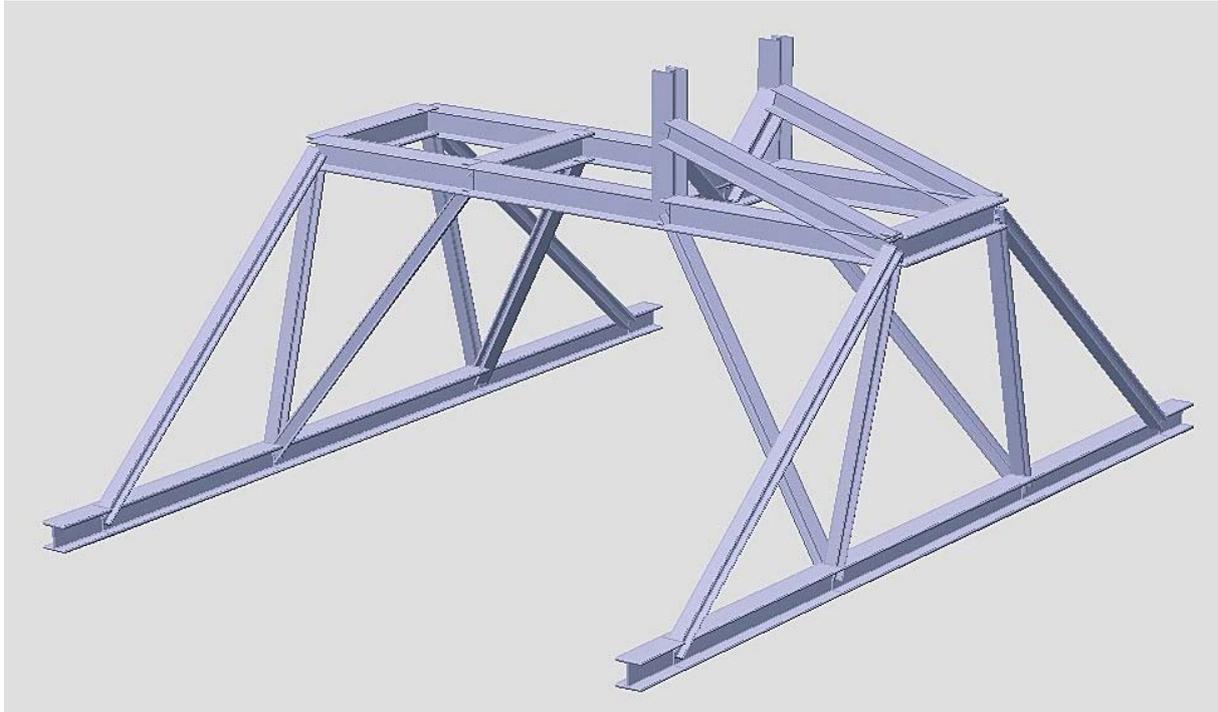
Auflagerrahmen im Dachstuhl des Zwischenflügels Nord mit Festlager in Längsrichtung und Federlagerung in Querrichtung
